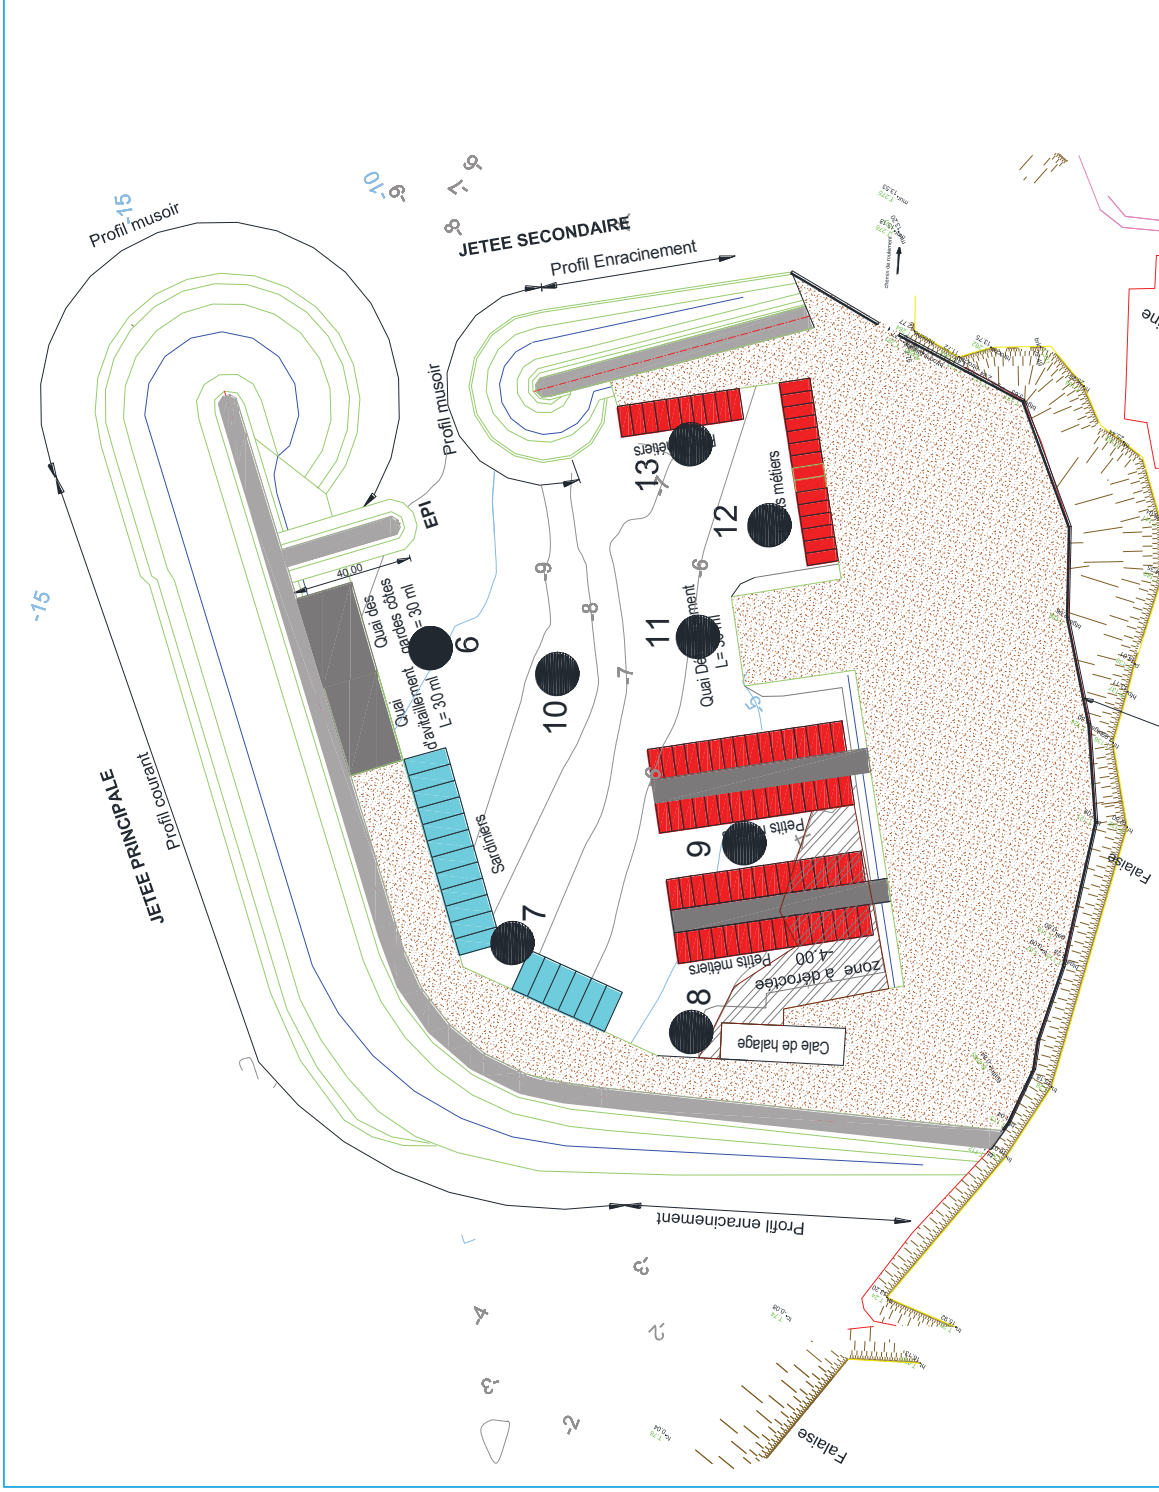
Plan de masse de la variante 2 (APS) et positionnement des sondes
